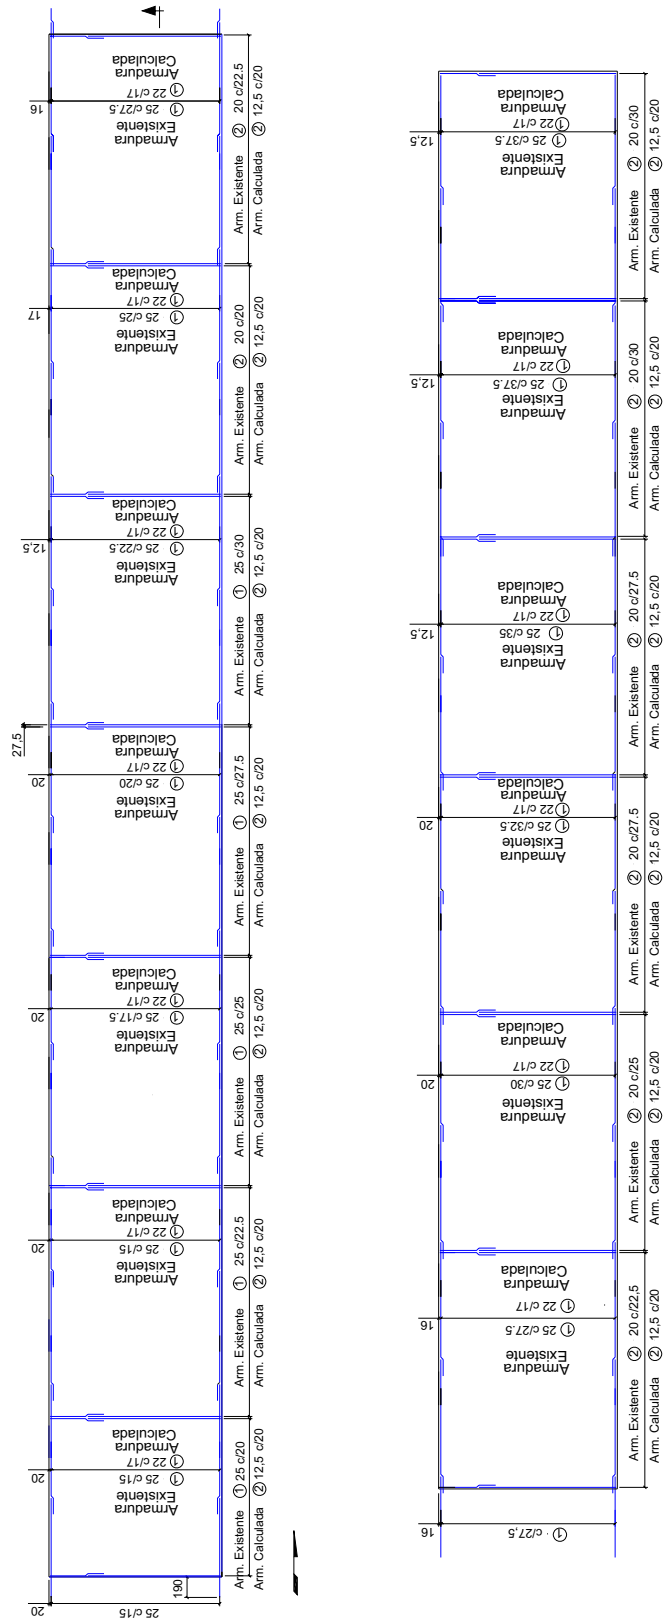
Distribuição da armadura em planta para a laje principal do painel 20.
